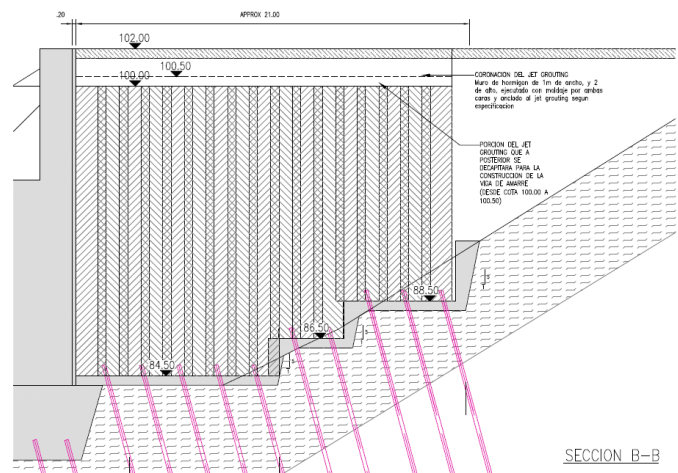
Vista en Corte Longitudinal de la Pantalla de Jet Grouting.
